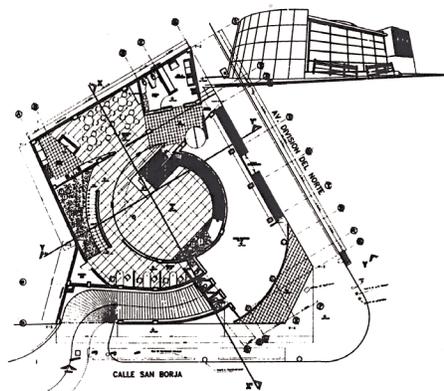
Planta arquitectónica de la Fundación Alzheimer (Baumgartner, 1997)
